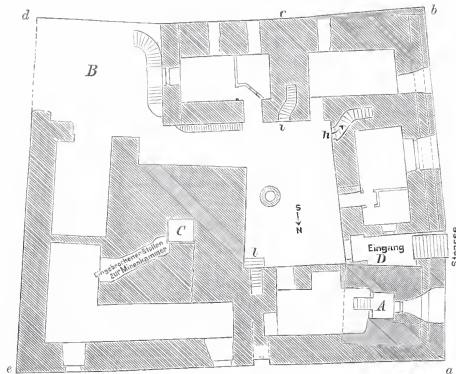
Grundriss vom Keller und I. Gaden.
